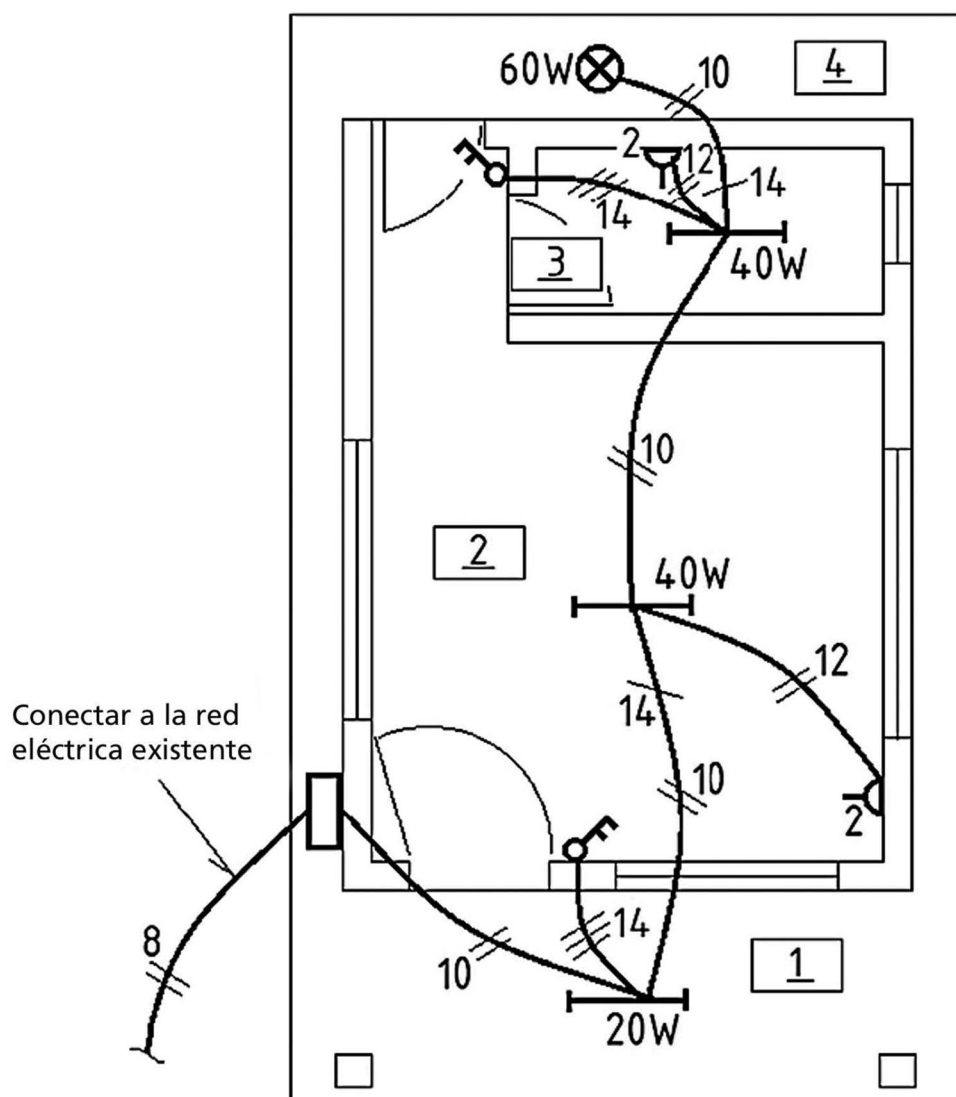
Plano de instalación eléctrica en obra arquitectónica
